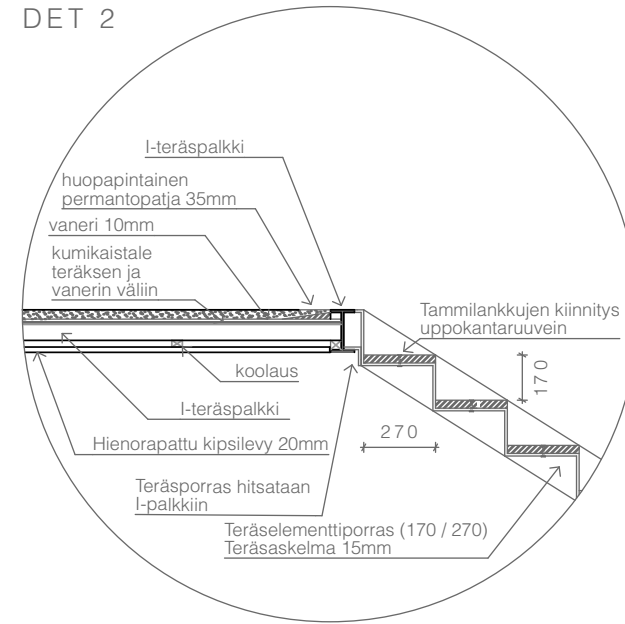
Parven kantava rakenne on I-palkisto, joka tukeutuu massiivitiilisiin sekä teräsvetotangolla meijerisalalin katossa jo olemassa olevaan teräspalkkiin. Teräsporras tukeutuu parveen ja massiivitiiliseen. Rakenneratkaisujen ansiosta portaan ja parven alapuolisia kantavia rakenteita ei tarvita, jolloin kokonaisuudesta muodostuu siro ja ilmava.
